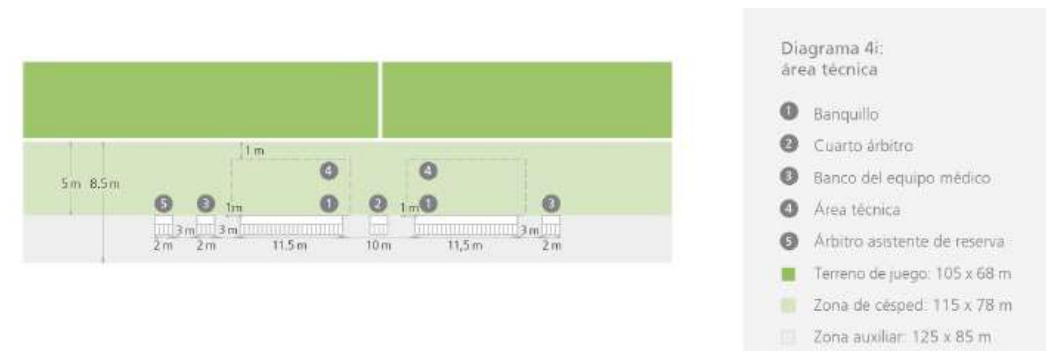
Dimensiones oficiales de la zona técnica de fútbol.
